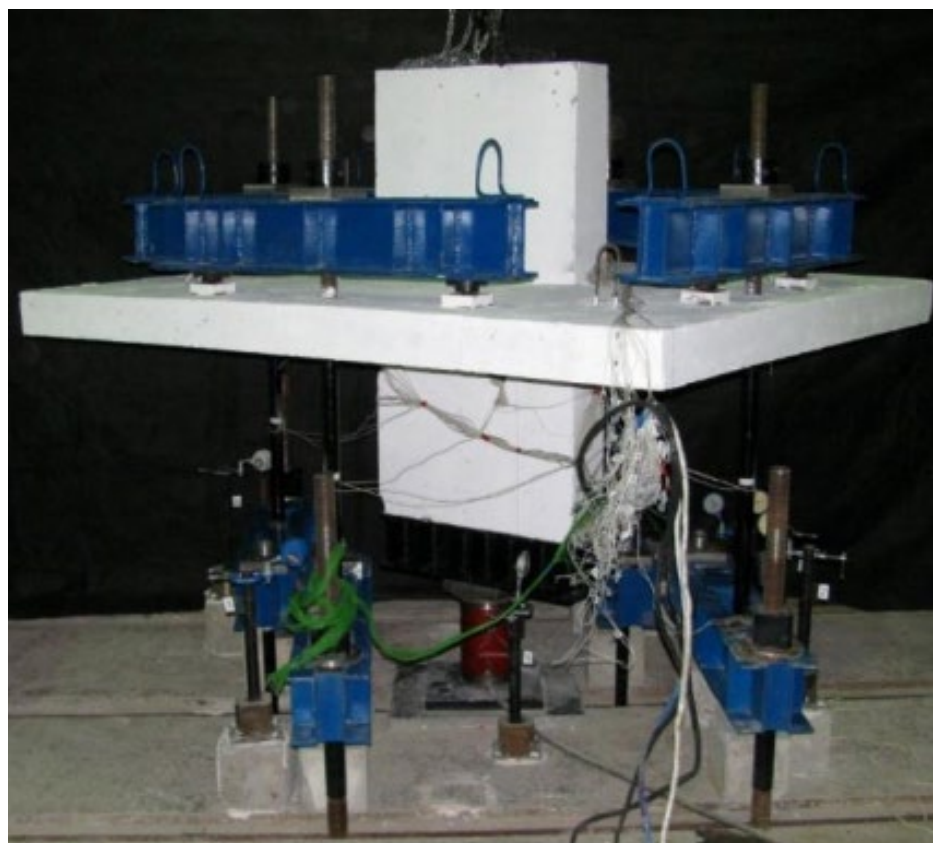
Общий вид испытательного стенда для исследования опорной зоны плиты
